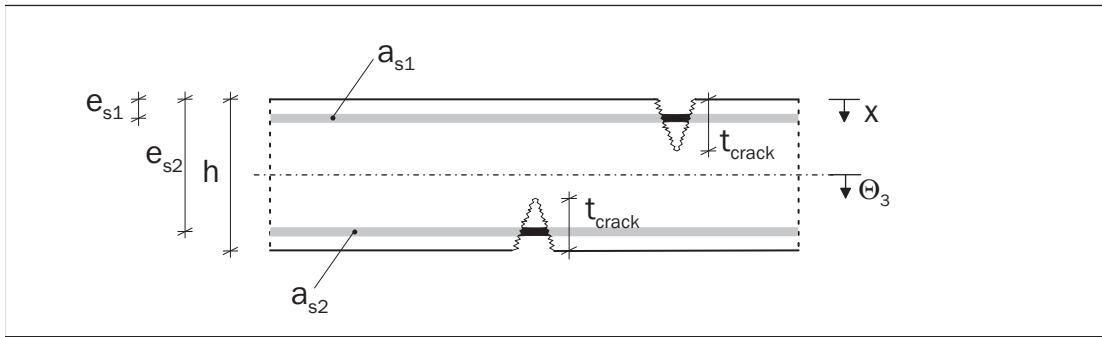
Versatz der Schwerlinie in einem gerissenen bewehrten Stahlbetonquerschnitt
